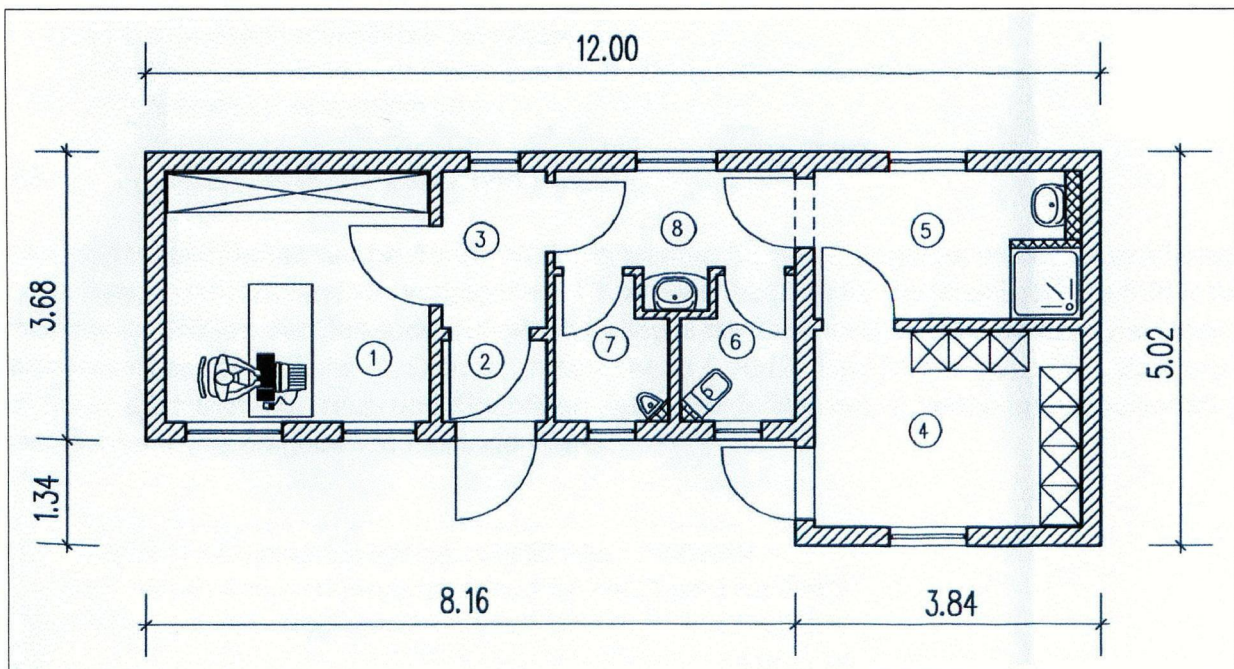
Grundriss des geplanten Betriebsgebäudes (Entwurf: Udo Rank, Änderung: RIK)
